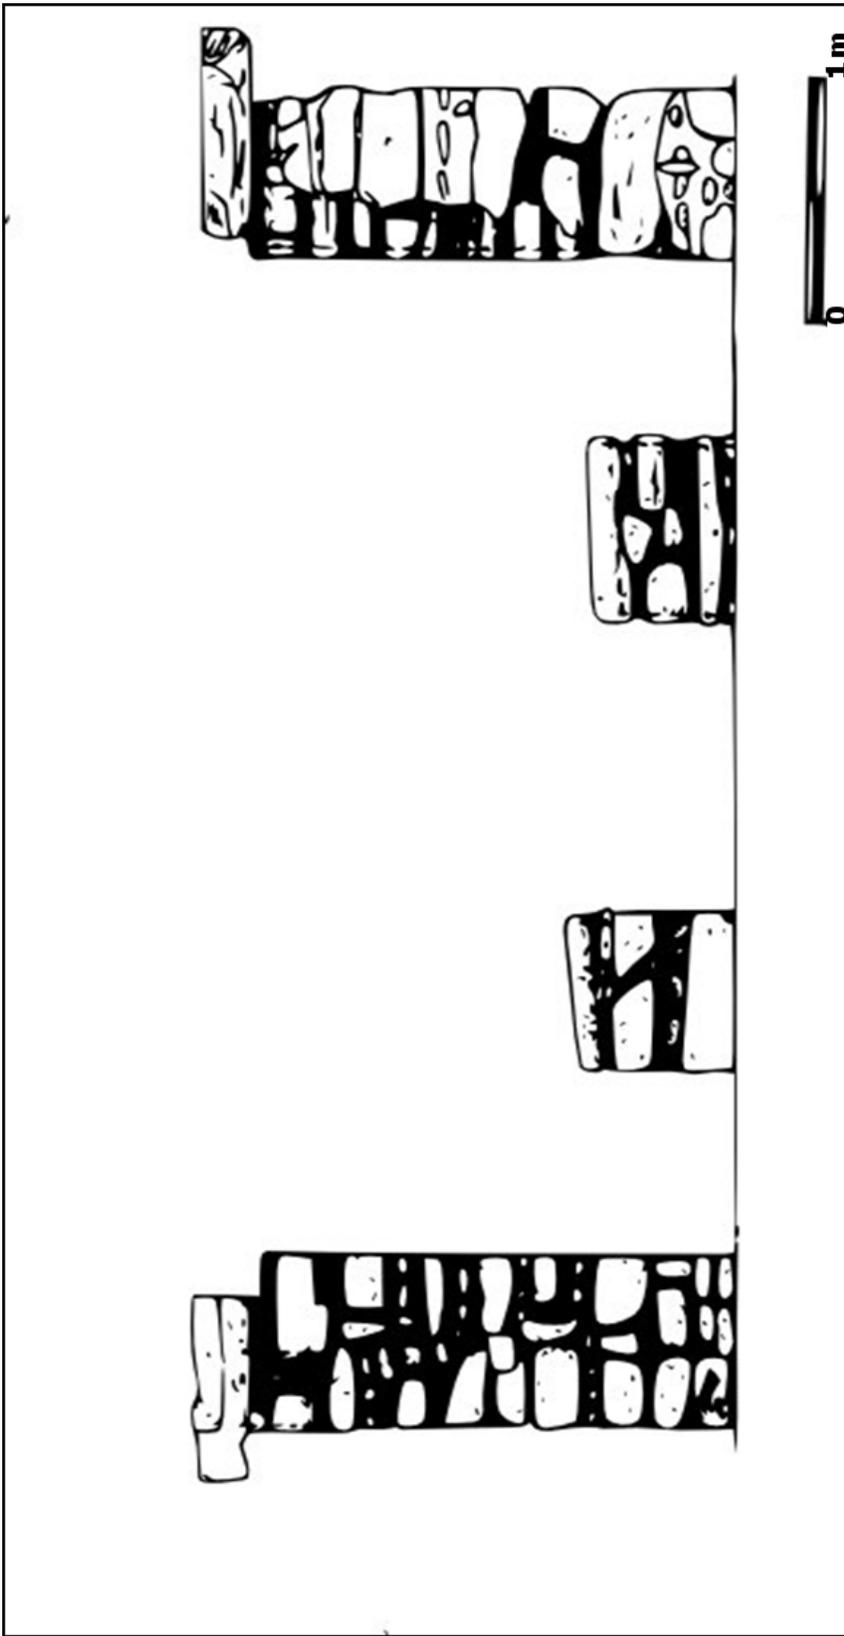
Fachada sur de columnas Edificio B quinta fase (Dibujo B. Aguilar).
